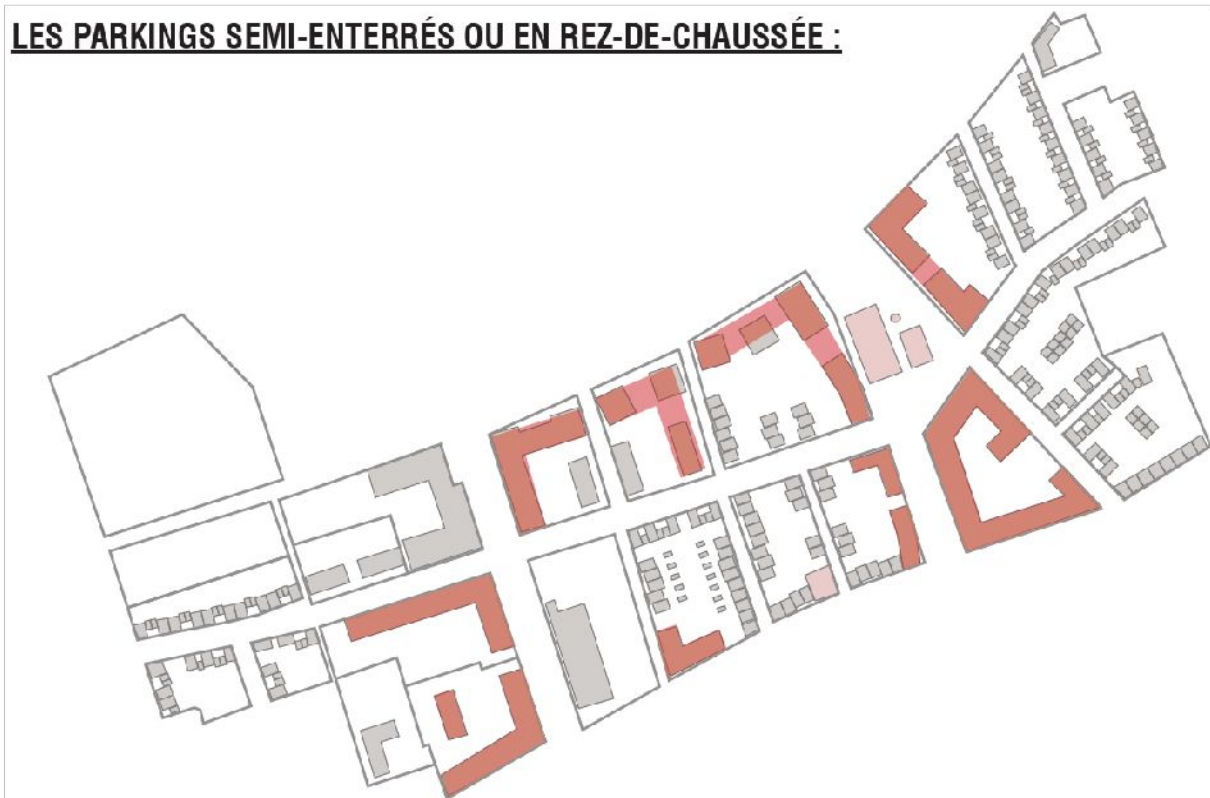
Localisation des parkings enterrés ou en rez-de-chaussée – Source : CPAUPE
